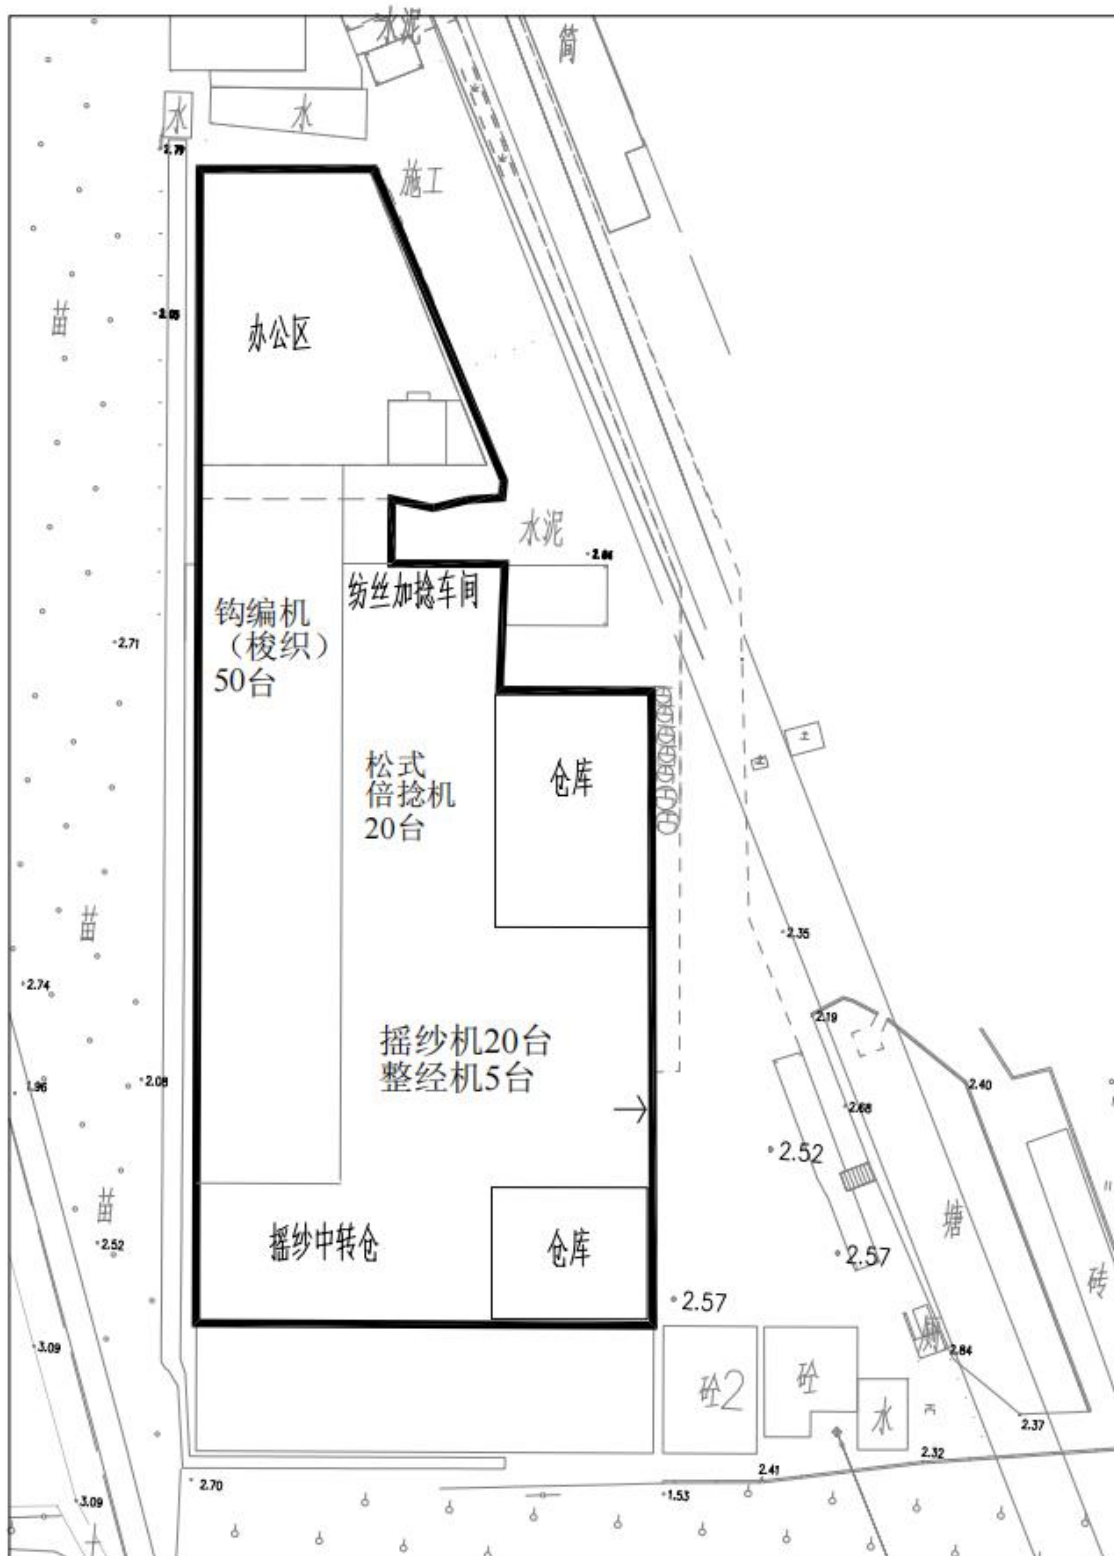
项目三层平面布置图（比例尺 1: 600）
